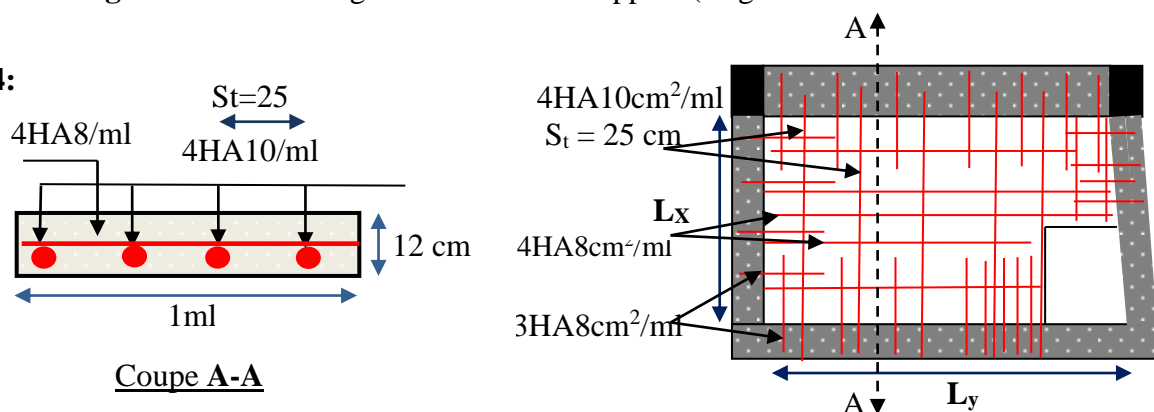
ferrailage de la dalle sur 4 appuis (duplex 1)
